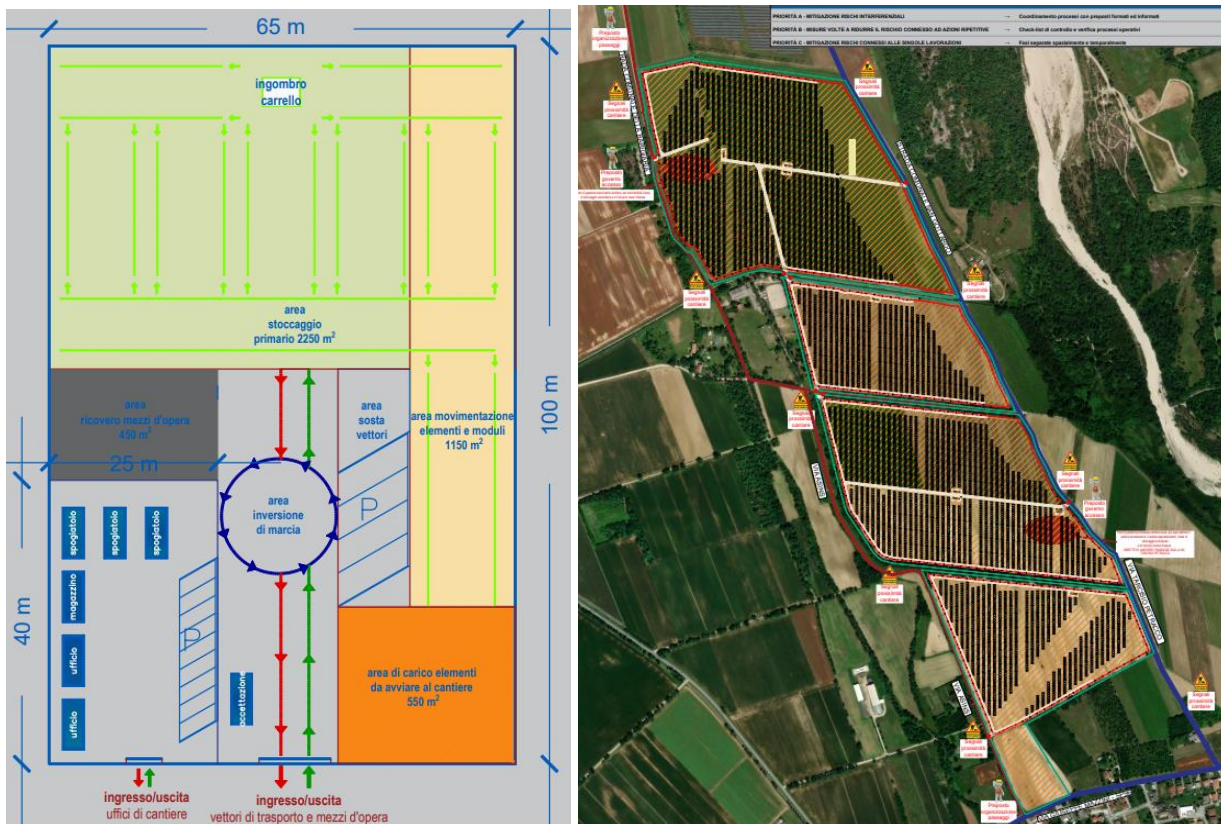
Stralci dal Piano di cantierizzazione; a sinistra schema del polo di gestione
